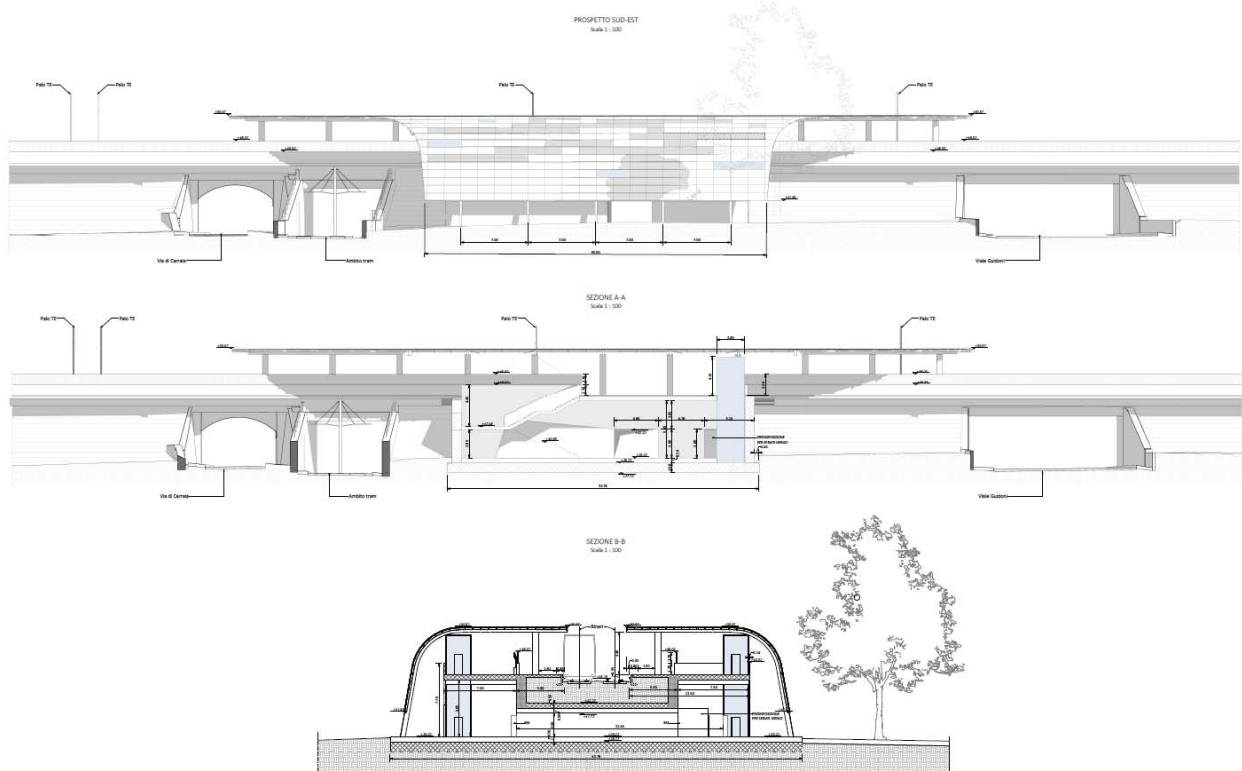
sezioni e prospetti FV (dall'alto Prospetto SUD-EST; Sezione longitudinale ai binari; Sezione trasversale ai binari)
